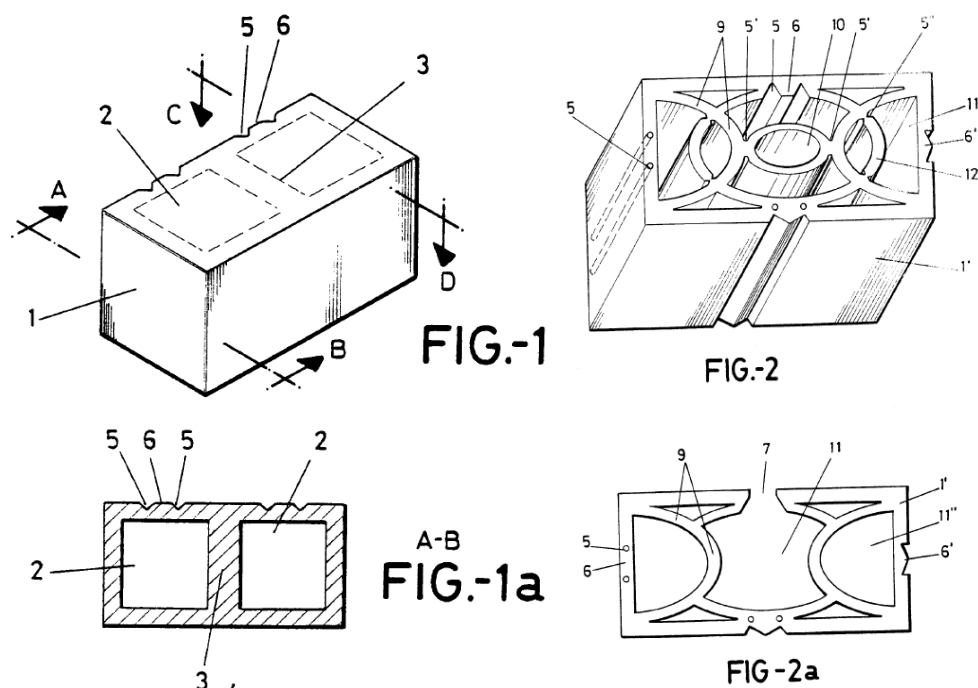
Patente de bloque para armadura vertical de Adell. Piezas de bloque de hormigón (izquierda) y de ladrillo cerámico (derecha).
